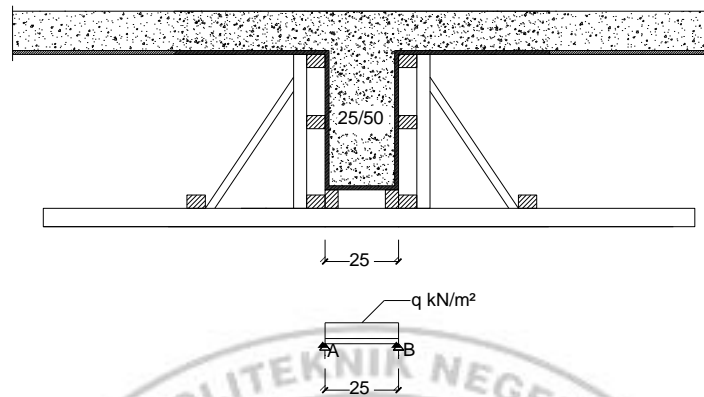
Pemodelan statik pada bekisting lantai tipe balok melintang
